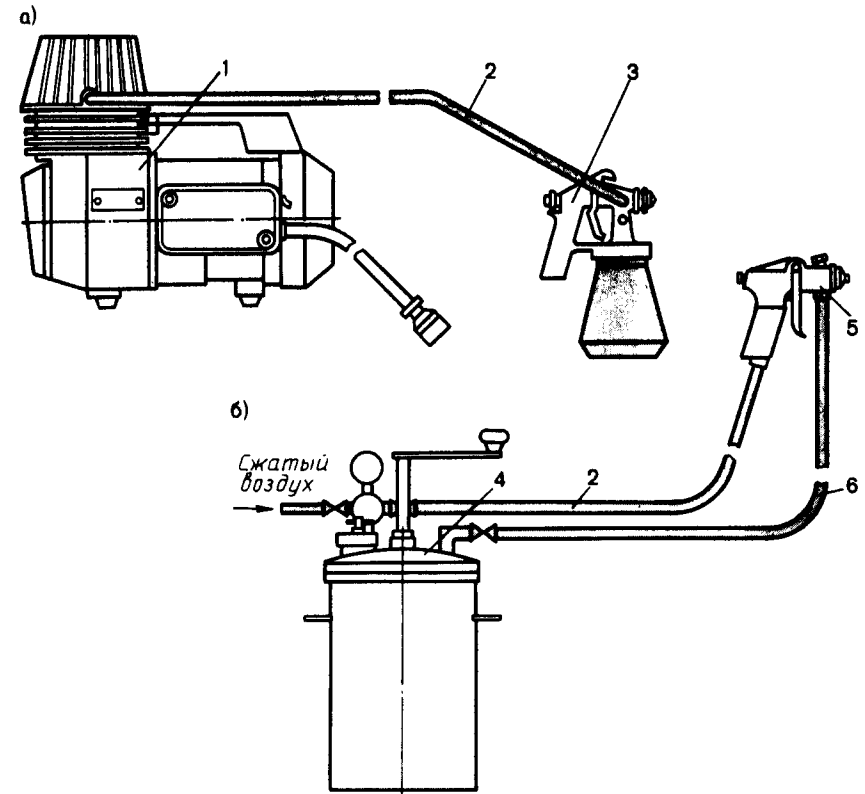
Окрасочные агрегаты пневматического распыления:
